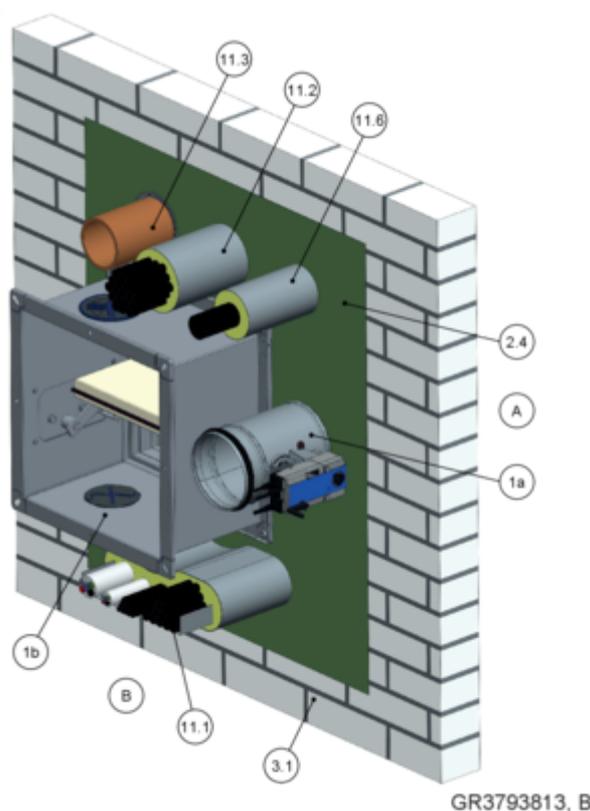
Vedante de passagem combinada (parede maciça desenhada)
